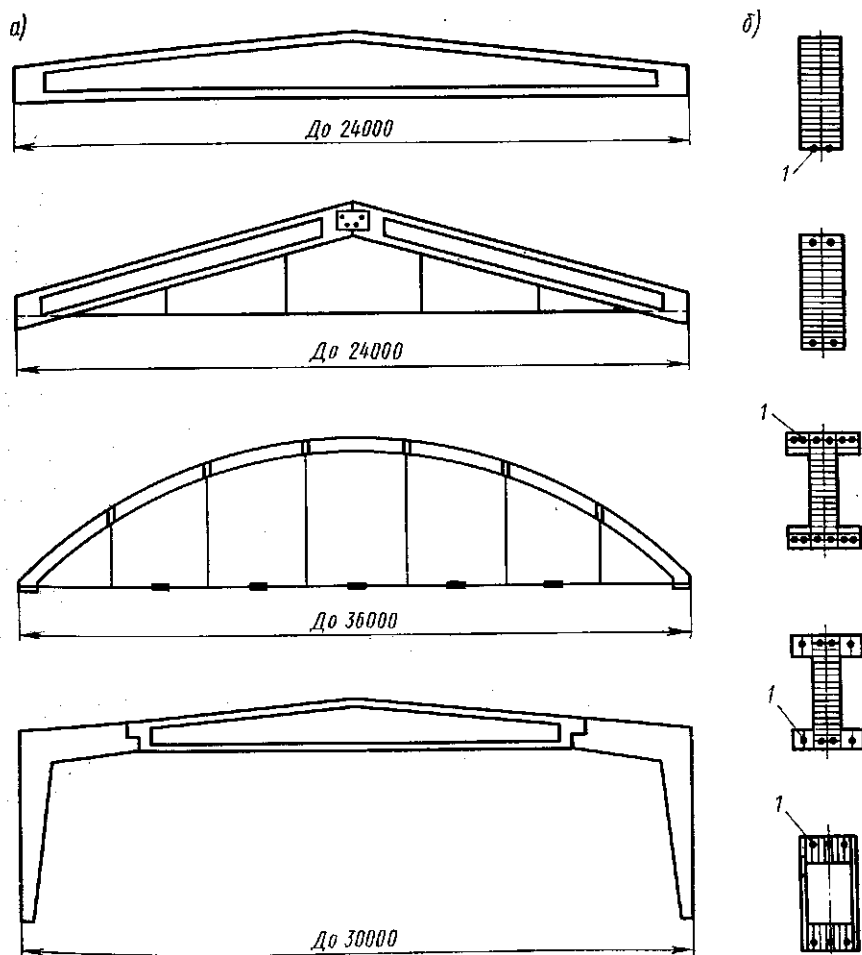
Армодеревянные клееные конструкции покрытий:
